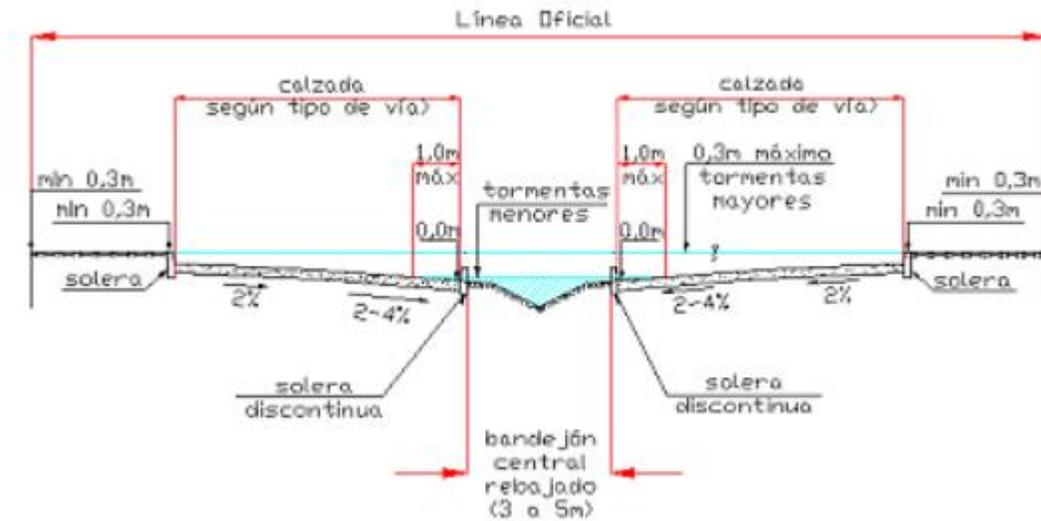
Alternativa de Sección Transversal en Pasajes.
